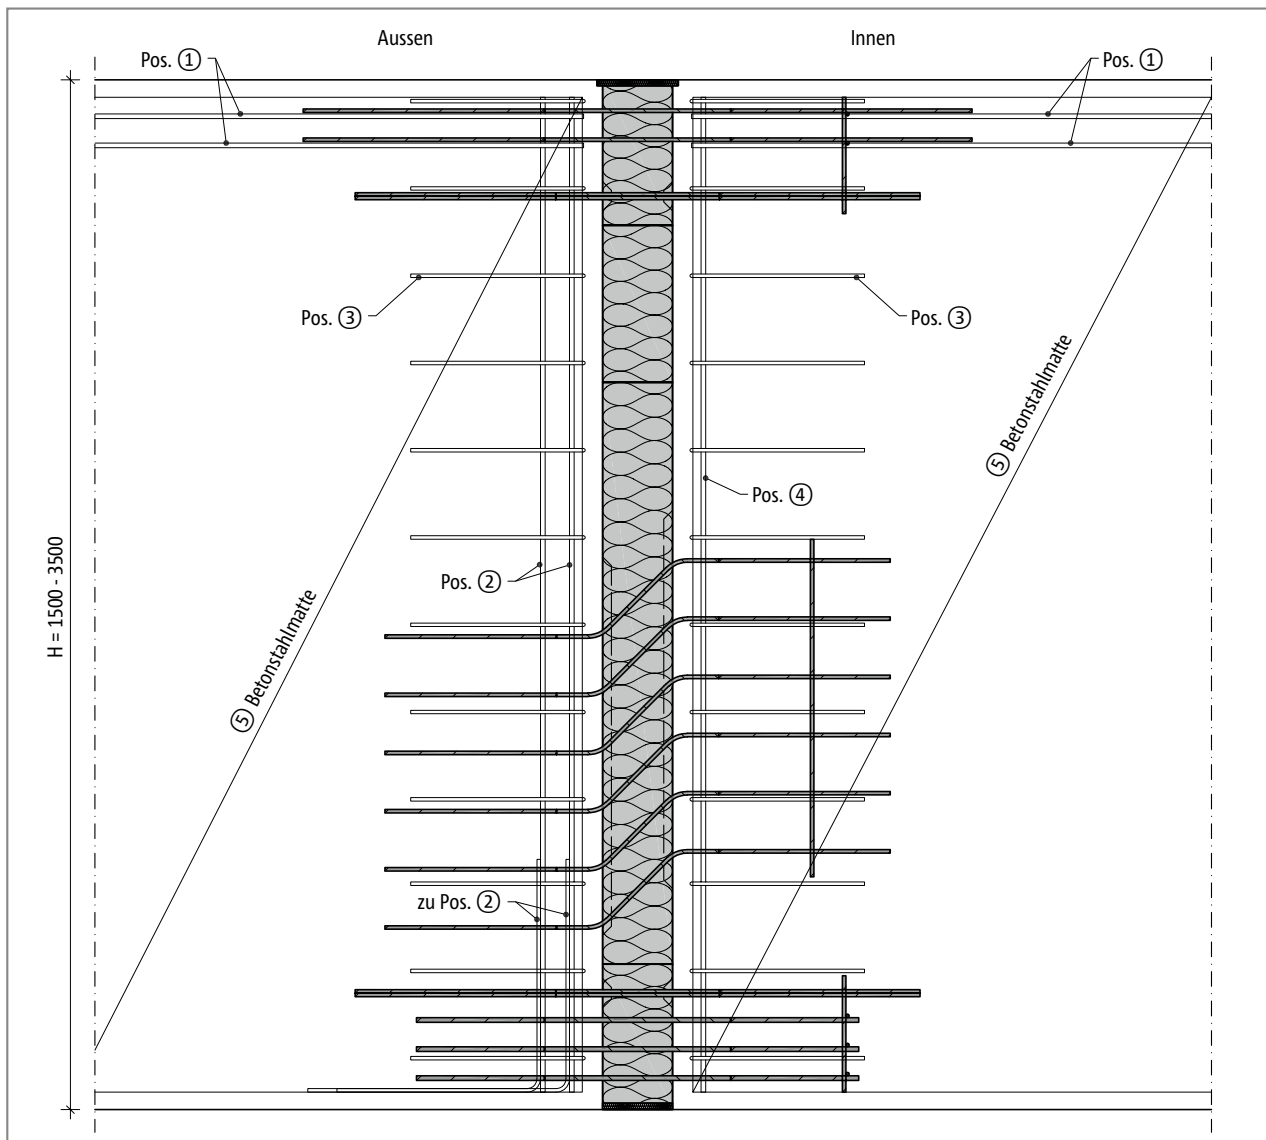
Schöck Isokorb® XT Typ WL: Bauseitige Armierung; Schnitt
